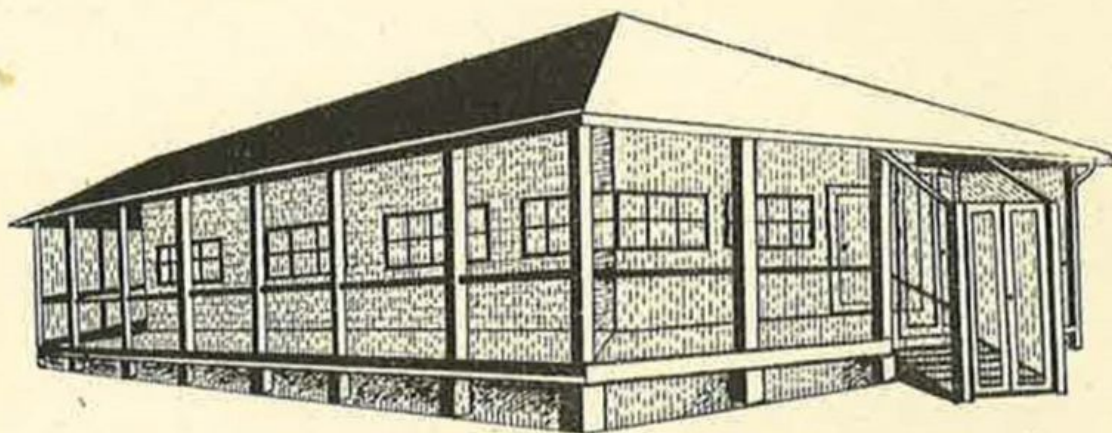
Tipo schematico di casa coloniale, leggermente sopraelevata da terra, con finestre ampie, con veranda e porta d'ingresso munite di reti contro gl'insetti
